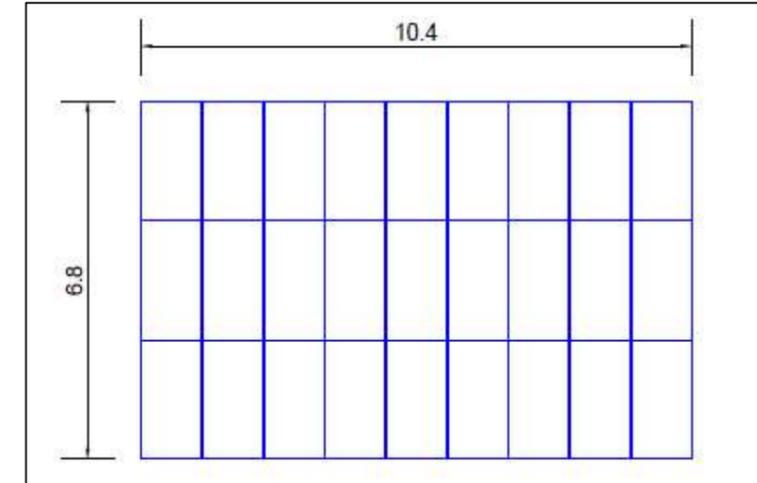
Vue en plan d'une structure 3 lignes sur 9 colonnes soit 27 panneaux (structure 3V9)
